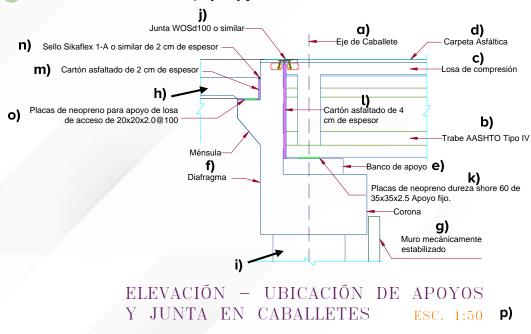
Ejemplo de ubicación de apoyos y junta en caballetes (elevación)
